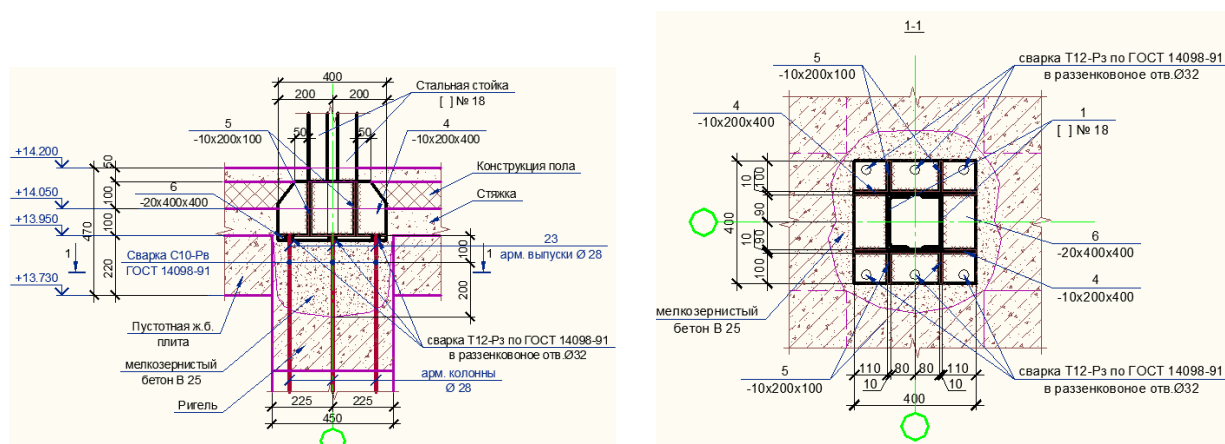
Деталь крепления стальной стойки на существующий железобетонный каркас
